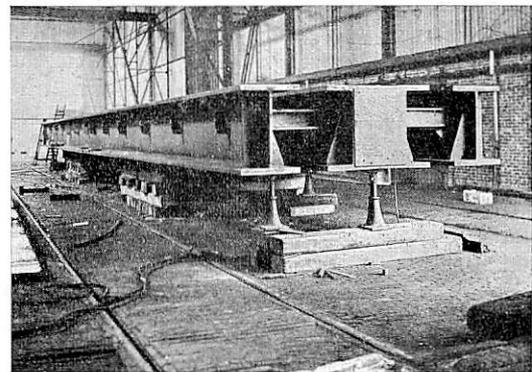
Eine der Brücken nach vollendeter Schweißung in der Werkstatt.
